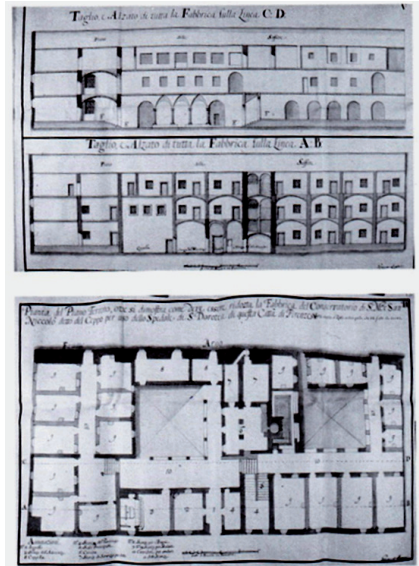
Pianta e alzato dello Spedale di Santa Dorotea de'Pazzi del 1643.
